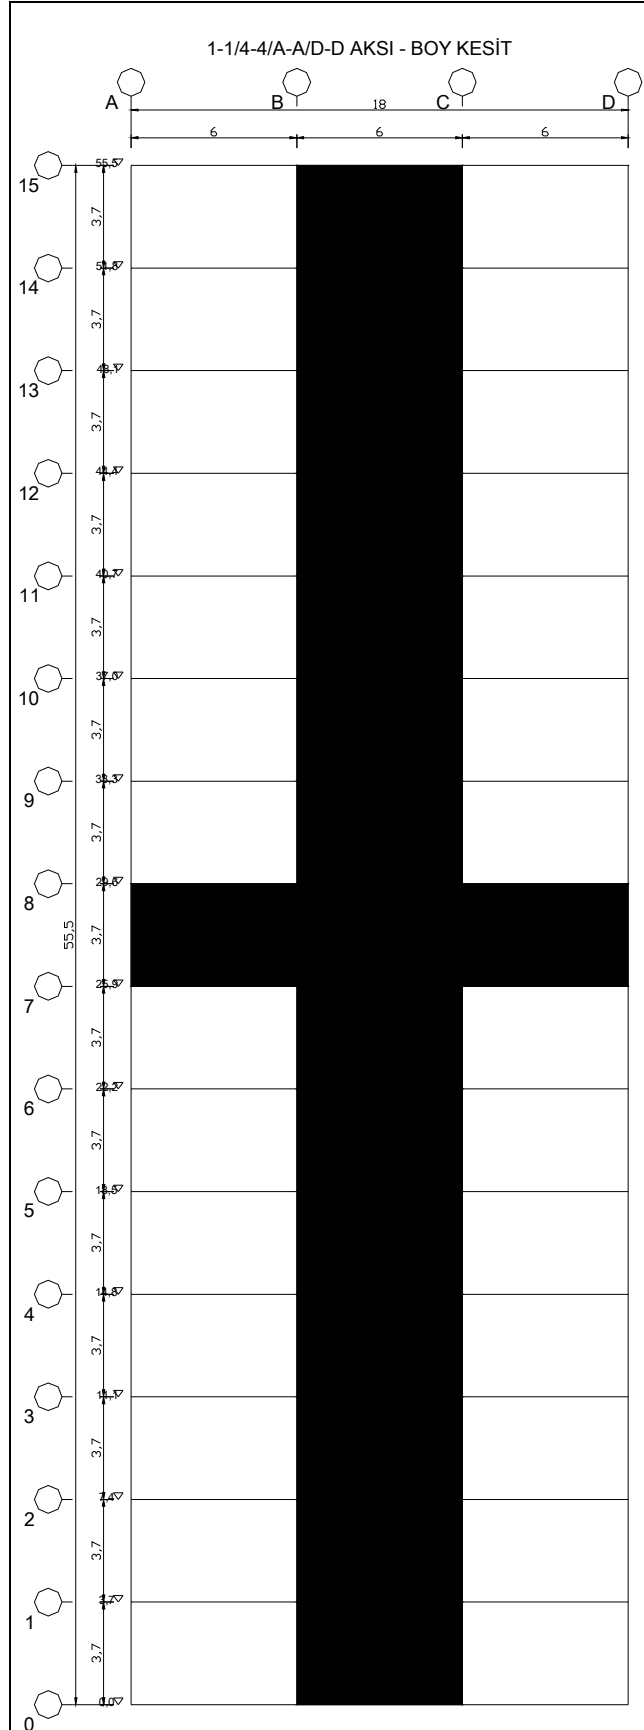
b: 5KP yapısının plan, görünüş, şekil değiştirmiş hali ve perspektifi.
